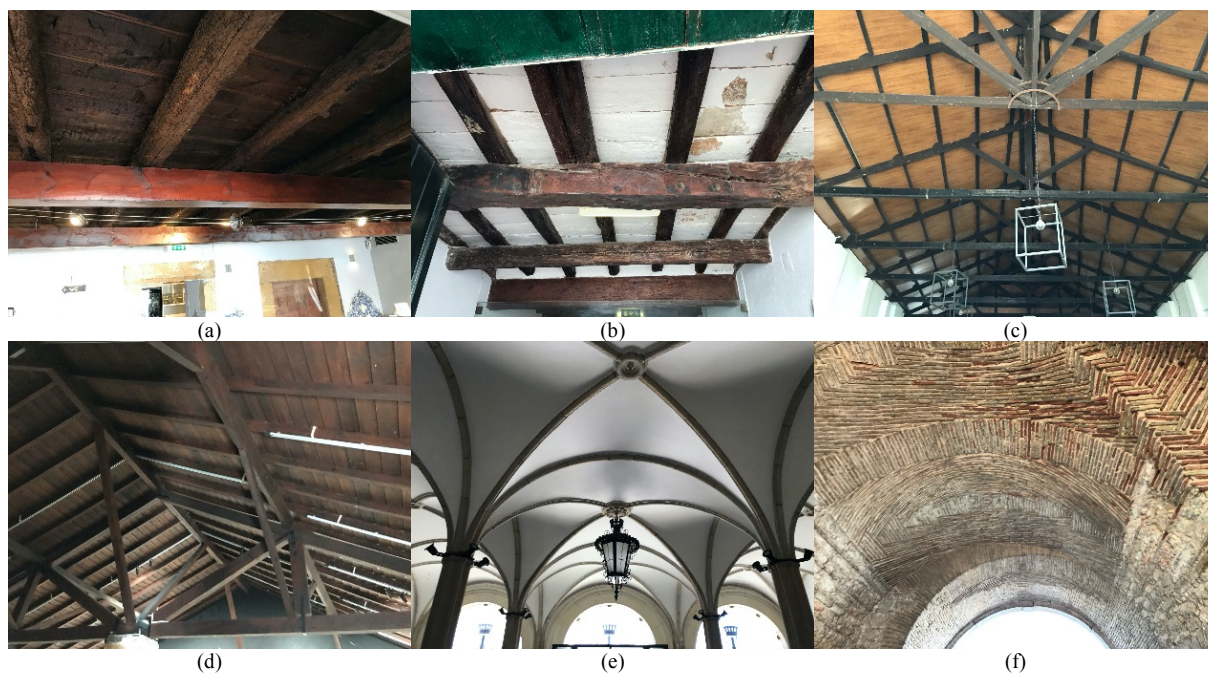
Exemplos das diferentes soluções construtivas encontradas: (a) e (b) estrutura horizontal em madeira diretamente assente nas paredes, (c) e (d) Estrutura de cobertura em madeira, (e) e (f) Arcos e abóbadas.
